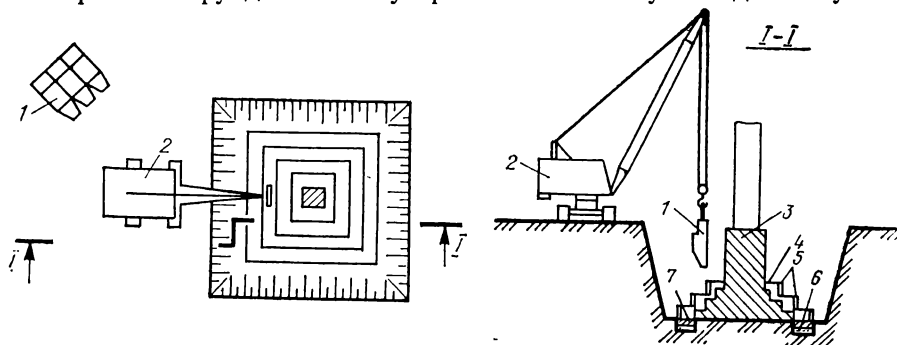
Усиление отдельно стоящих ступенчатых фундаментов:
